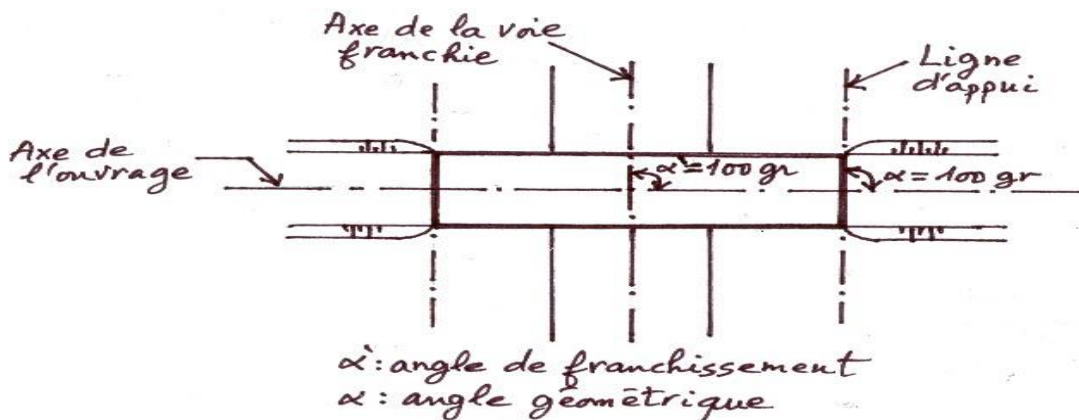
Vue en plan d'un pont droit en géométrie et en franchissement.
